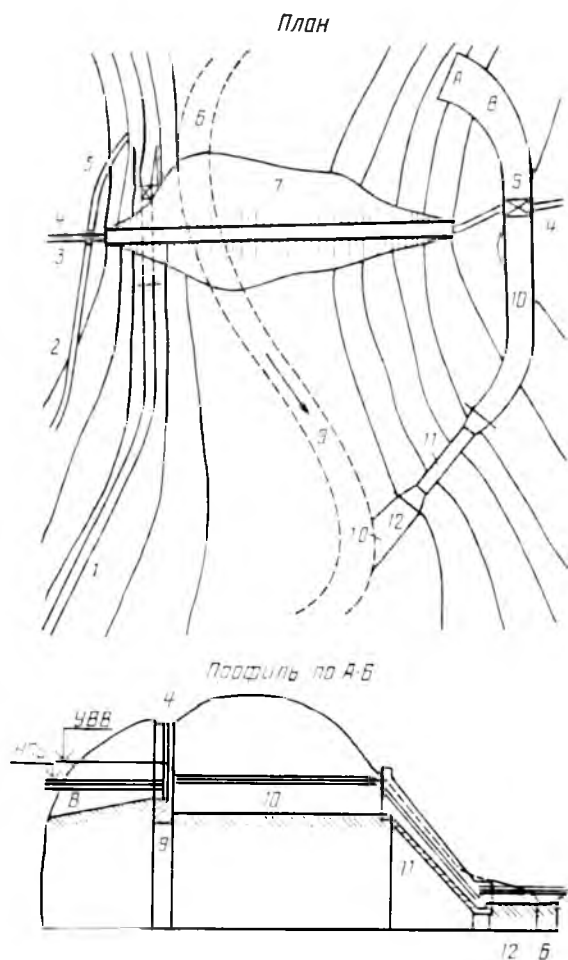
Схема гидроузла с грунтовой плотиной и открытым береговым водосбросом и водовыпуском:
